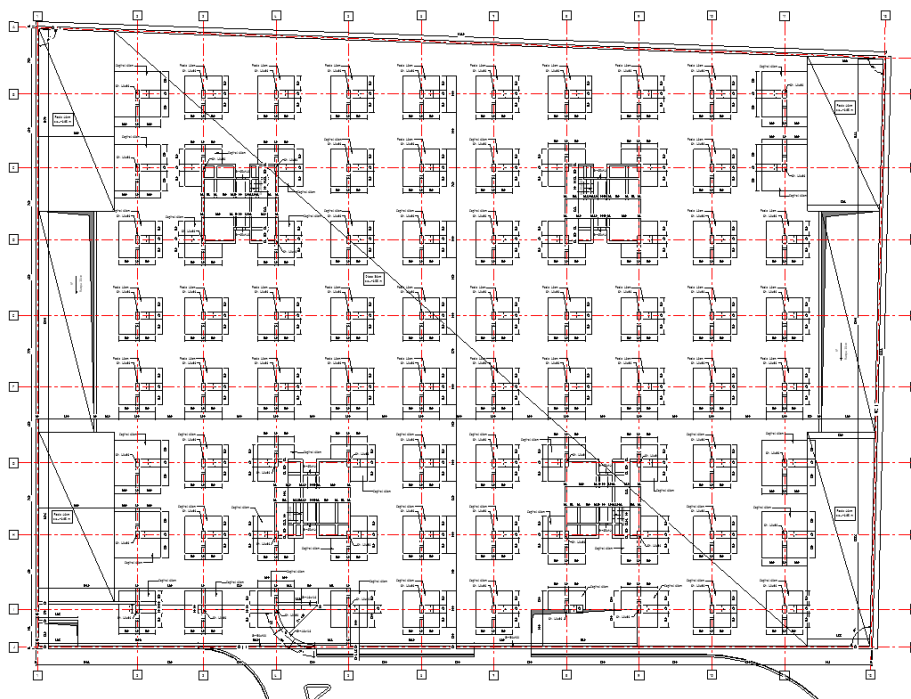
Vedere în plan planșeu peste Subsol 1
